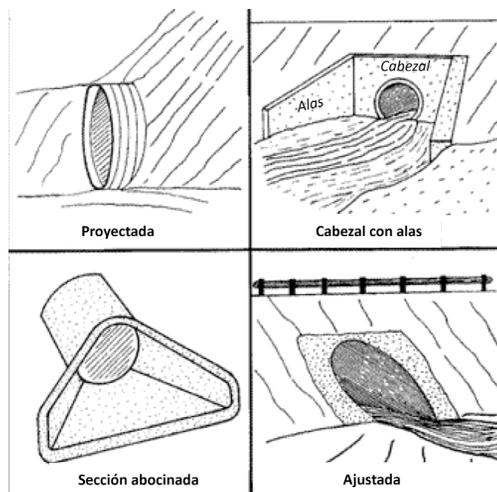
Tipos comunes de estructuras de salidas y entradas de alcantarillas.
